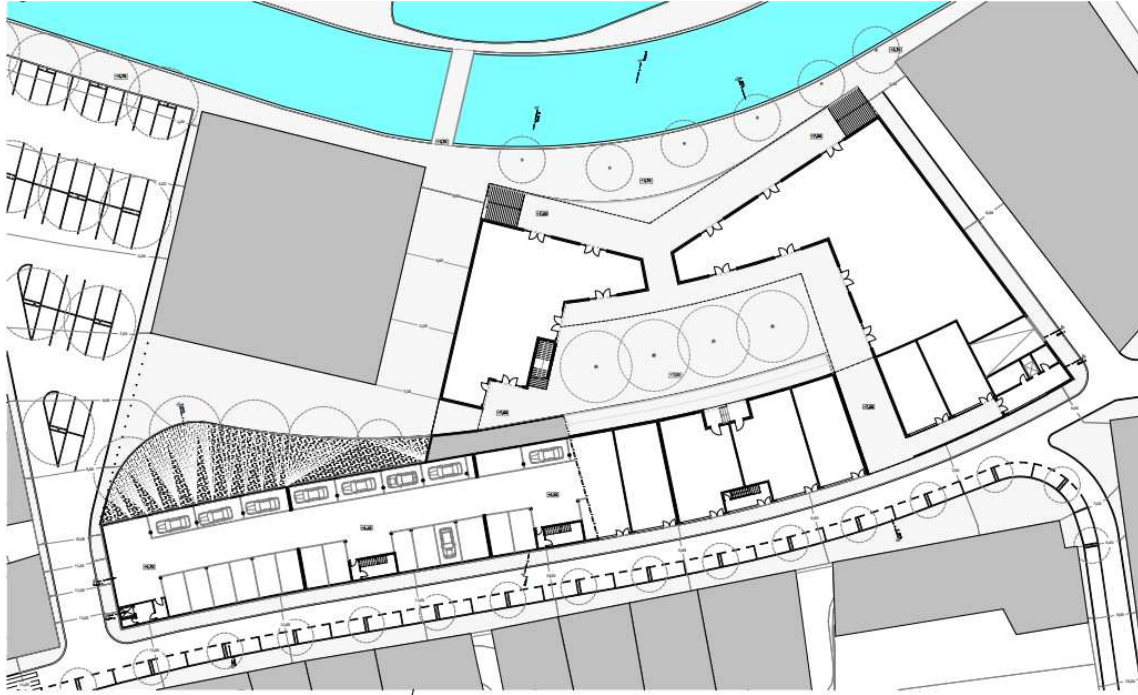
Painel final n.º3 - Habitação colectiva para jovens – Planta rés-do-chão I
